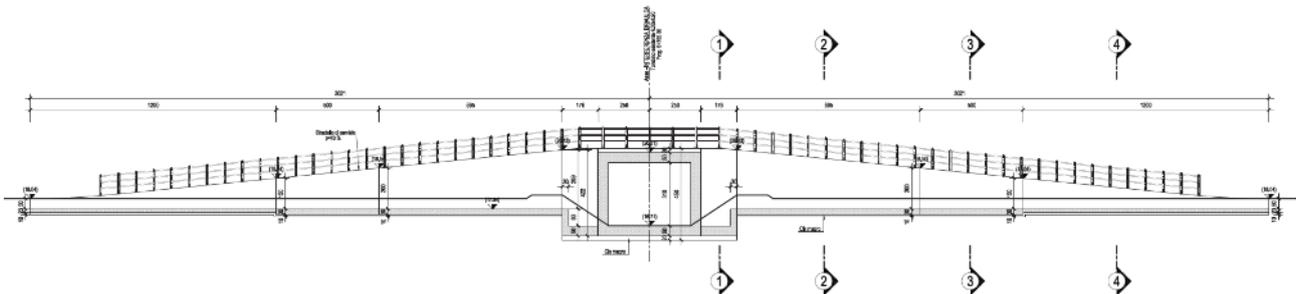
Ripristino stradello di servizio al Fosso Capoposta – Sezione longitudinale
